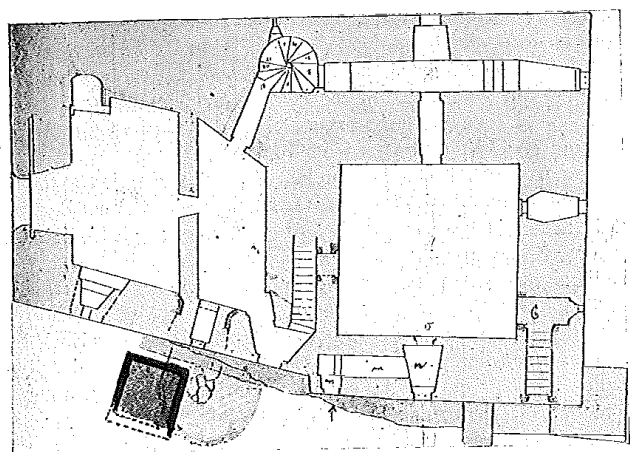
Plan av 1. etasje (av »Plade No. 1«).
